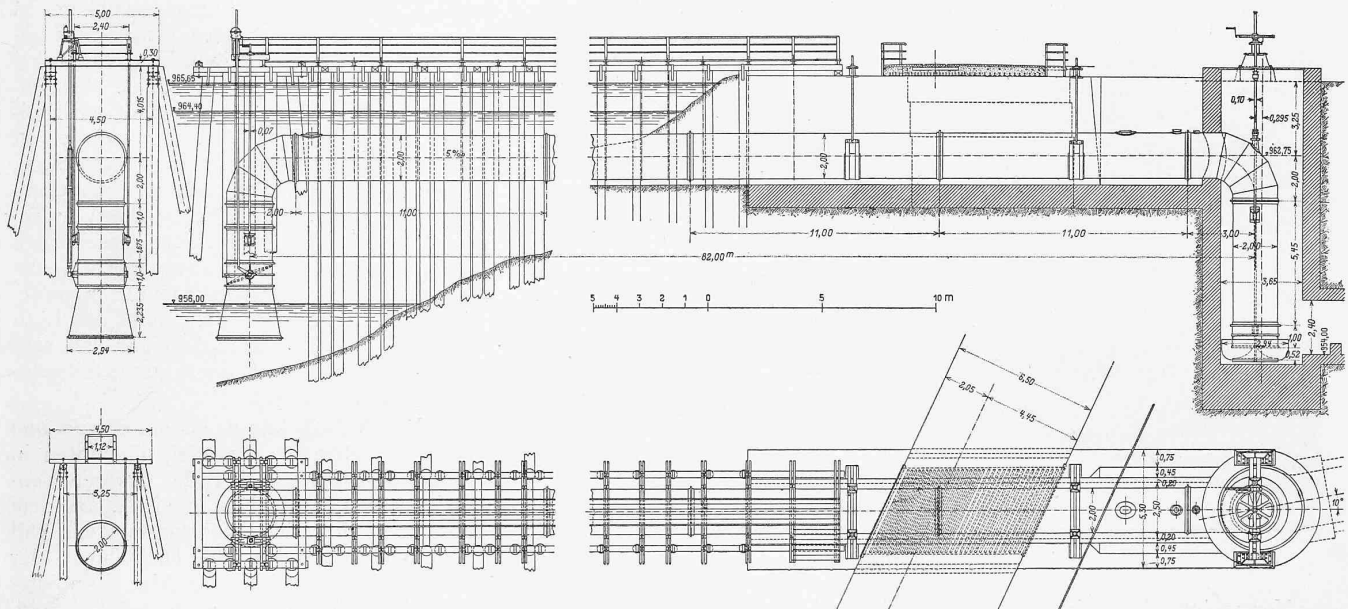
Die Heberleitung. — Ansicht, Grundriss und Schnitte. — Masstab 1 : 300.
